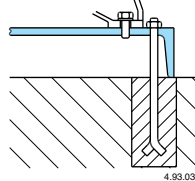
Detalle cimentación para grupo sobre bancada base de perfil único.
